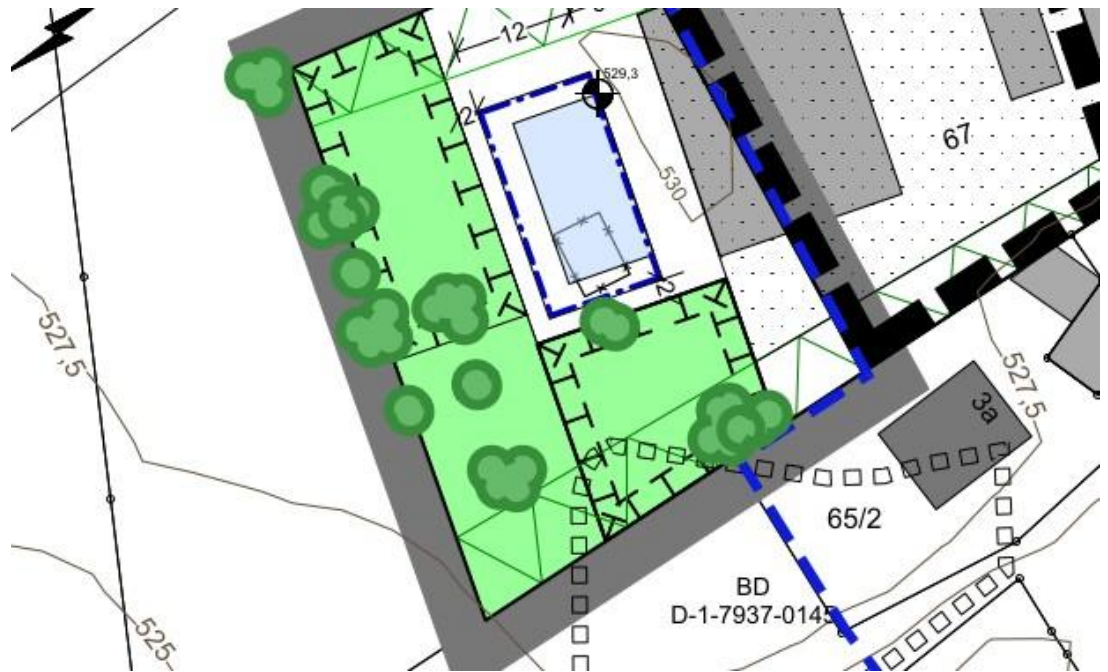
Ausschnitt Planzeichnung der EBS Straußdorf mit Baumbestand
